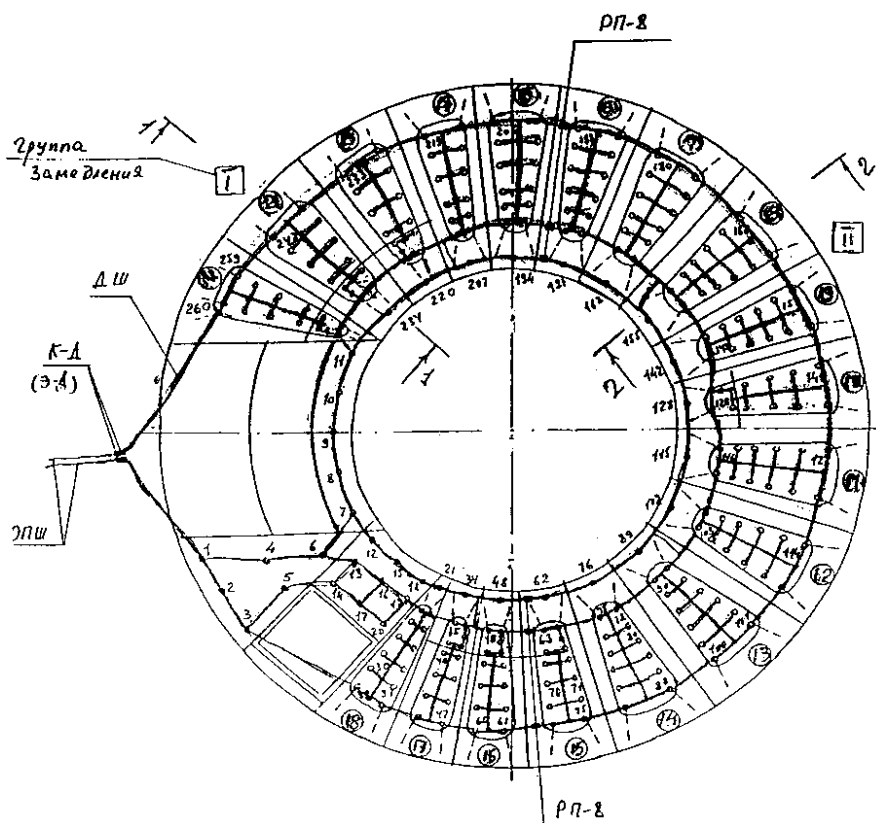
Схема расположения шпуров и монтажа взрывной сети при разрушении верхнего силового пояса
